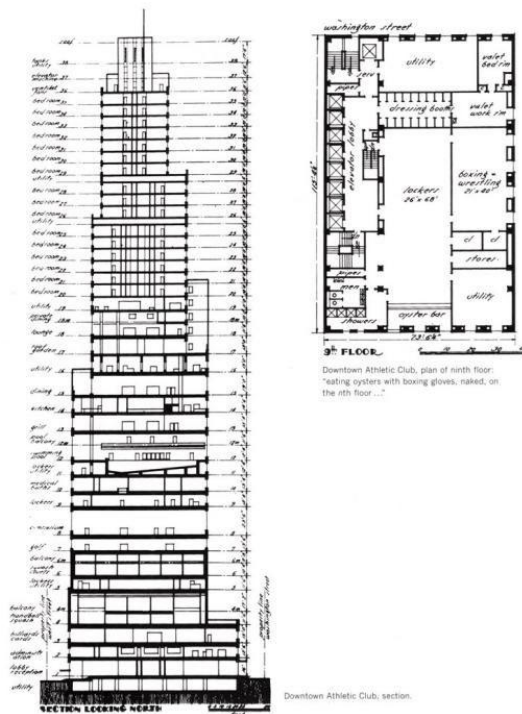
Starrett & Van Vleck, Downtown Athletic Club (1930), New York, coupe et plan
